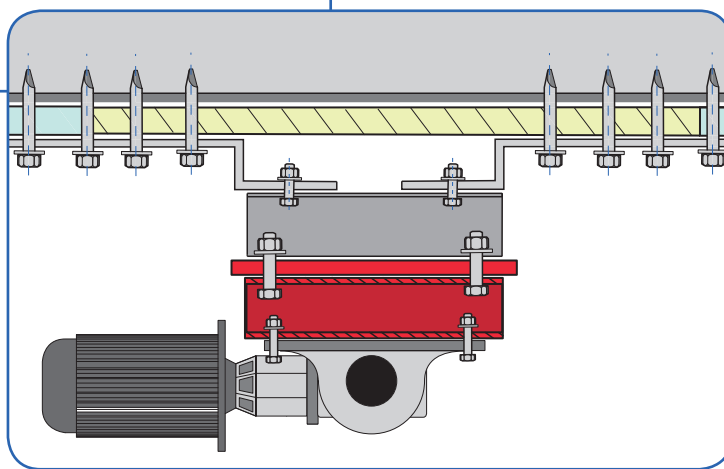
Detalle torno eléctrico en la cubierta. Colocación en el centro de la línea. VISTA FRONTAL
